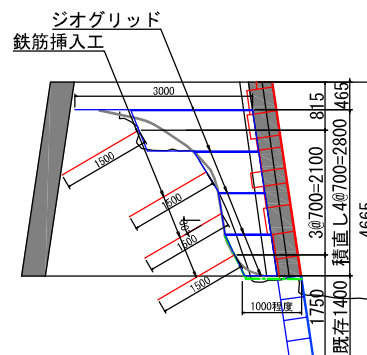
巻込み式ジオグリッド+鉄筋挿入工の断面図
